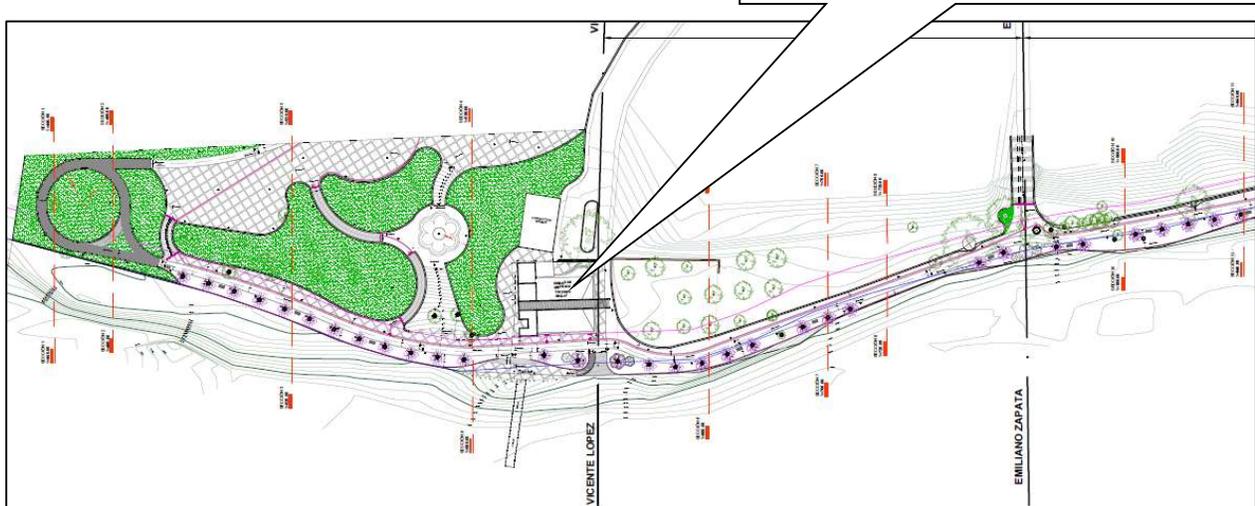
Planta arquitectónica Sección 1 del proyecto.
